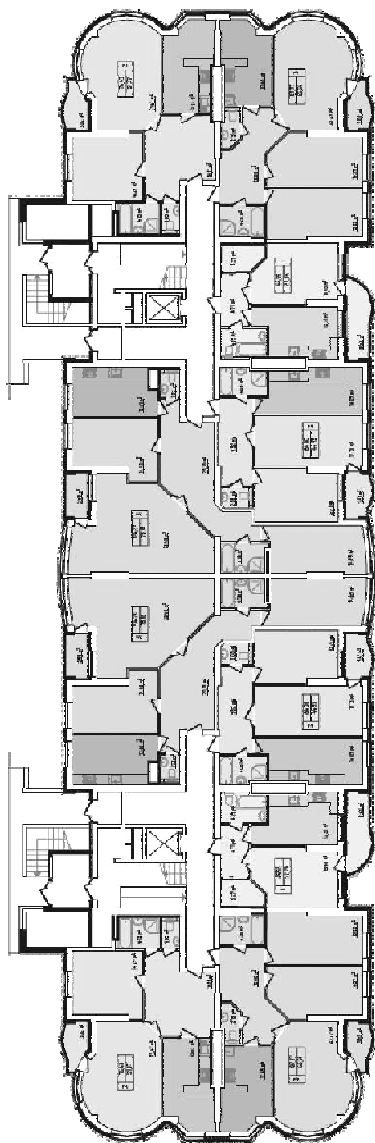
План 1-го поверху житлового комплексу «Lux House»
